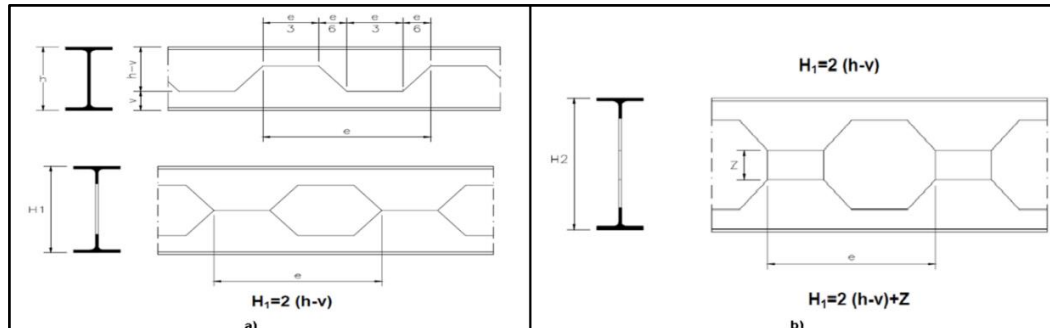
a) Proceso de construcción de viga de alma aligerada; b) Viga de alma aligerada peraltada. Fundación Tecnológica Antonio de Arevalo (2018)
